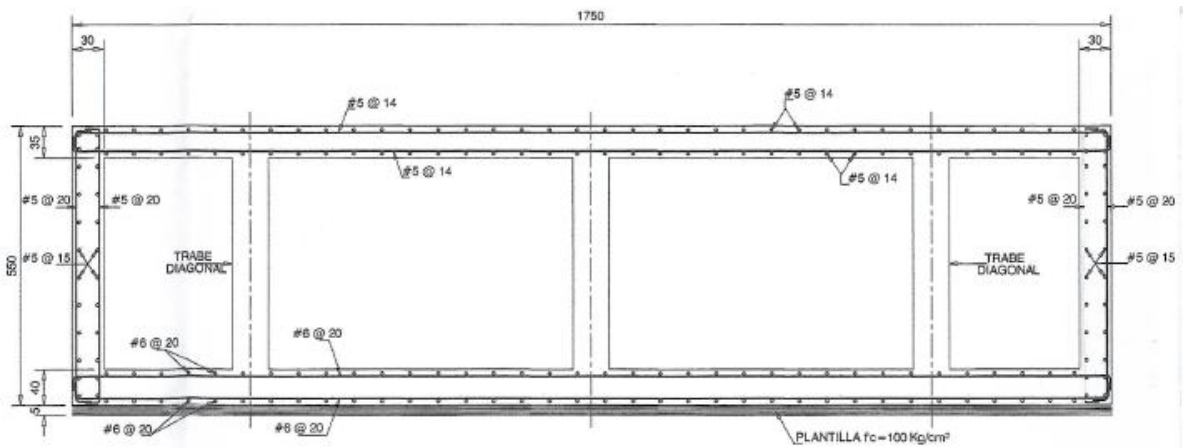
Corte longitudinal de armado de losa de fondo, muros y losa tapa
